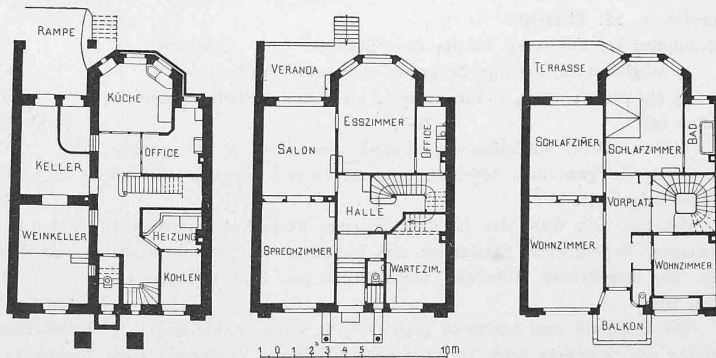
, 8, 9. Grundrisse vom Kellergeschoss, Erdgeschoss und ersten Stock des Hauses an der Arnold Böcklinstrasse. — Masstab 1 : 400.
